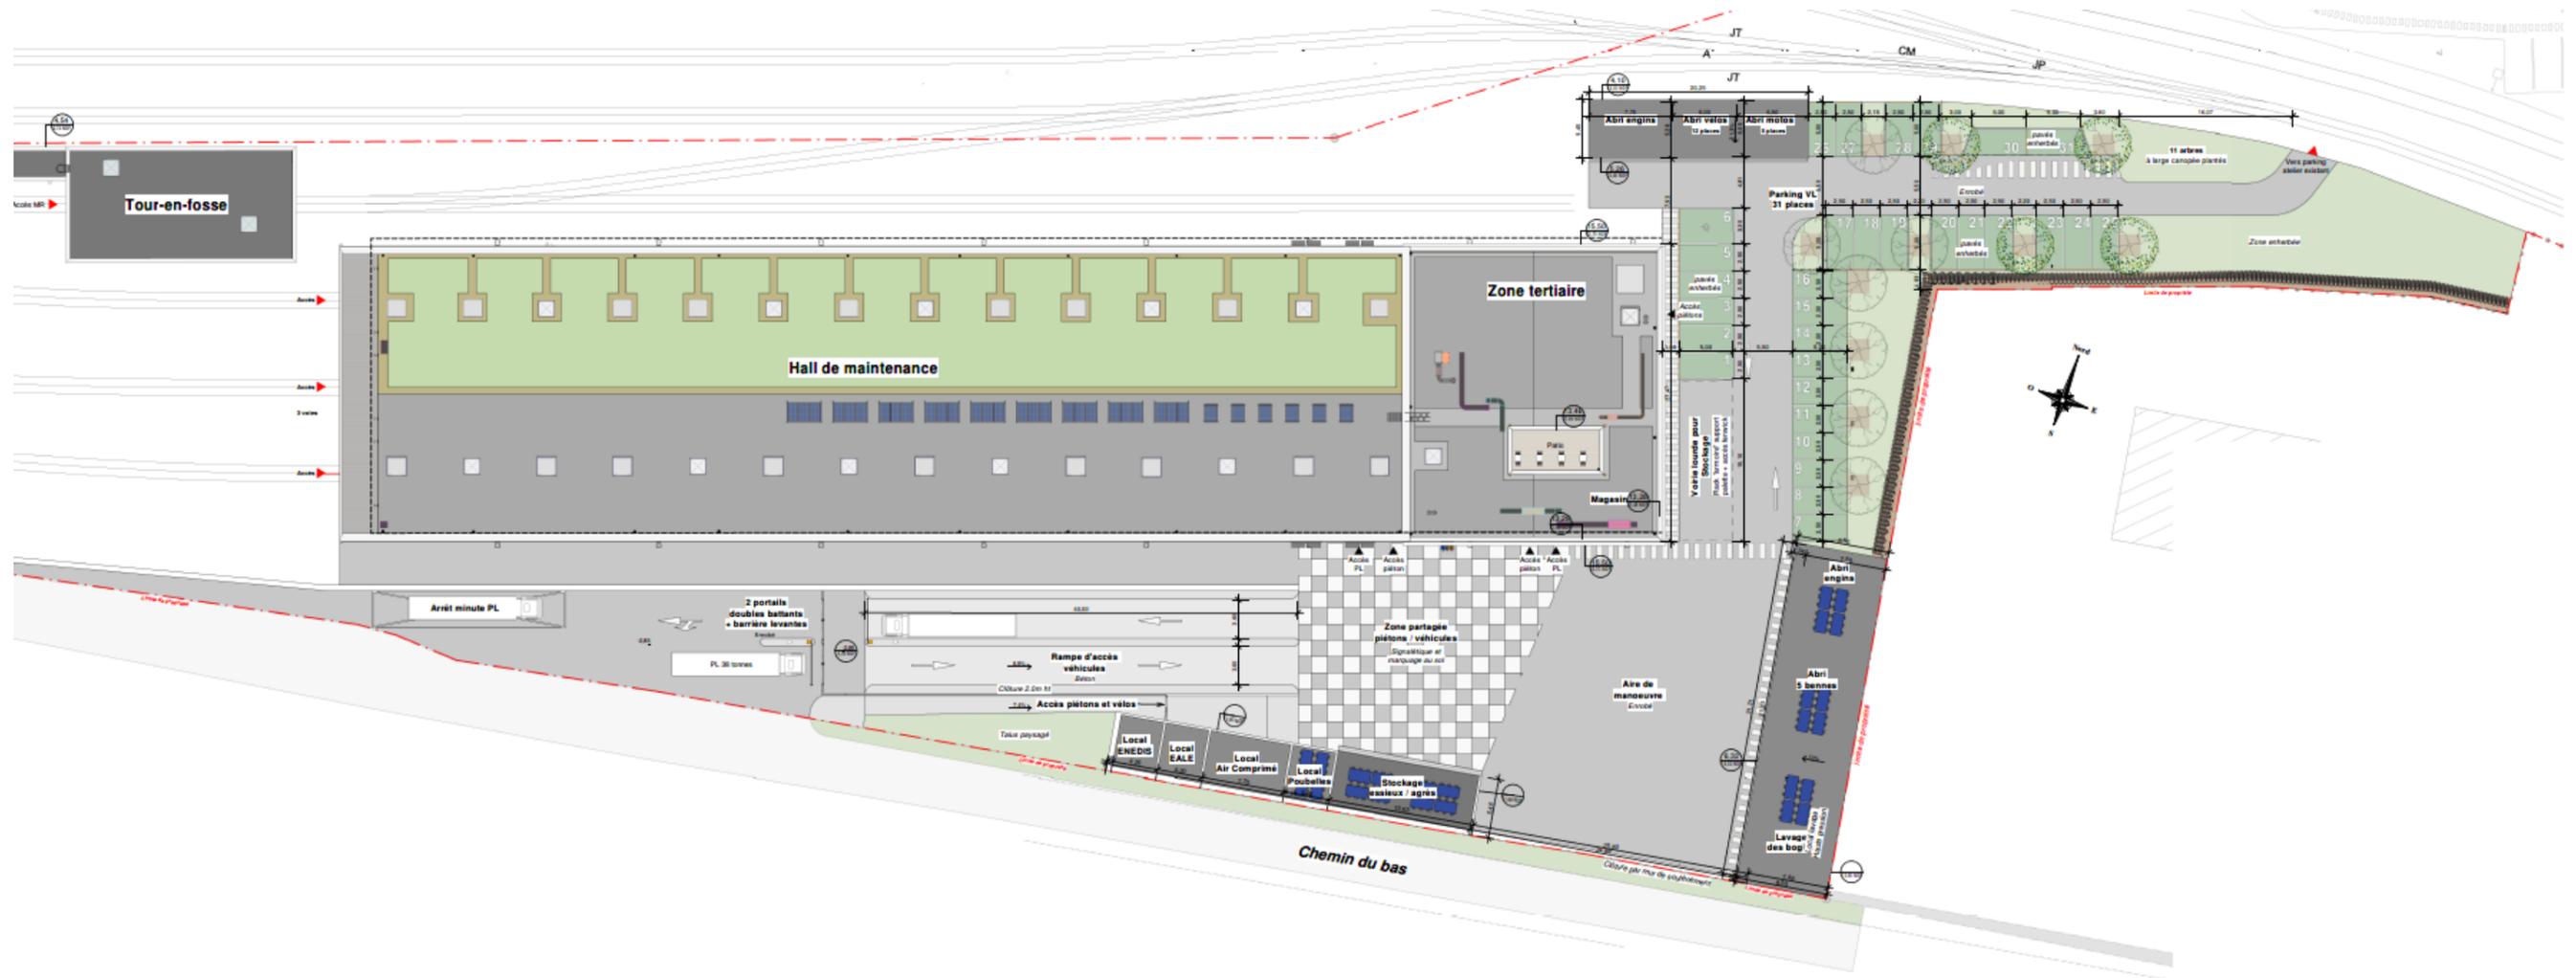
SCHEMA DES INSTALLATIONS FERROVIAIRES PROJETEES DU PERIMETRE TCSSL (OU ASL) (SOURCE : DOSSIER PRO)
